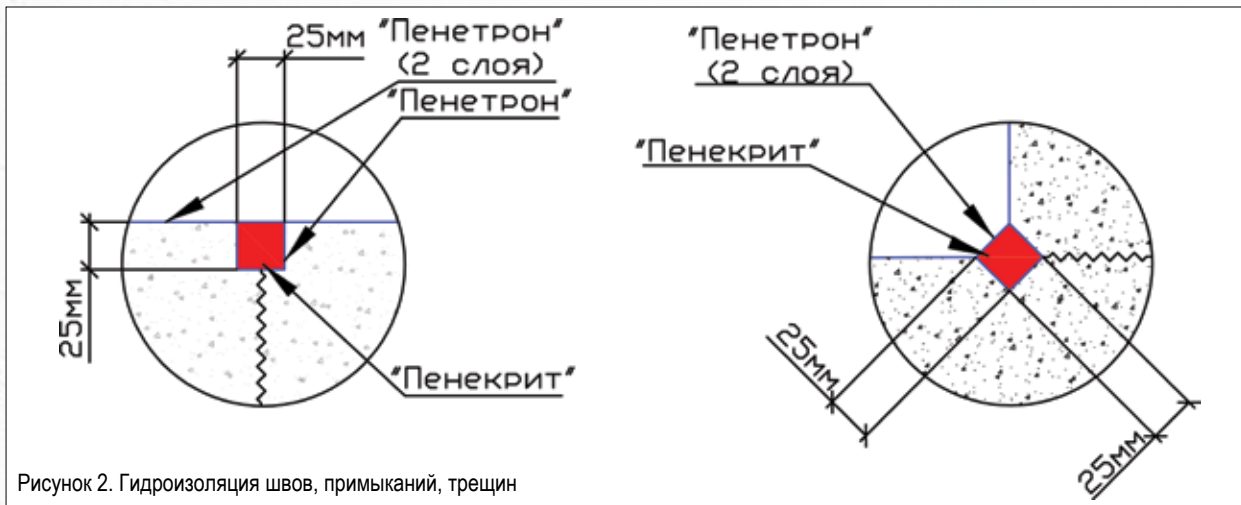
Гидроизоляция швов, примыканий, трещин
